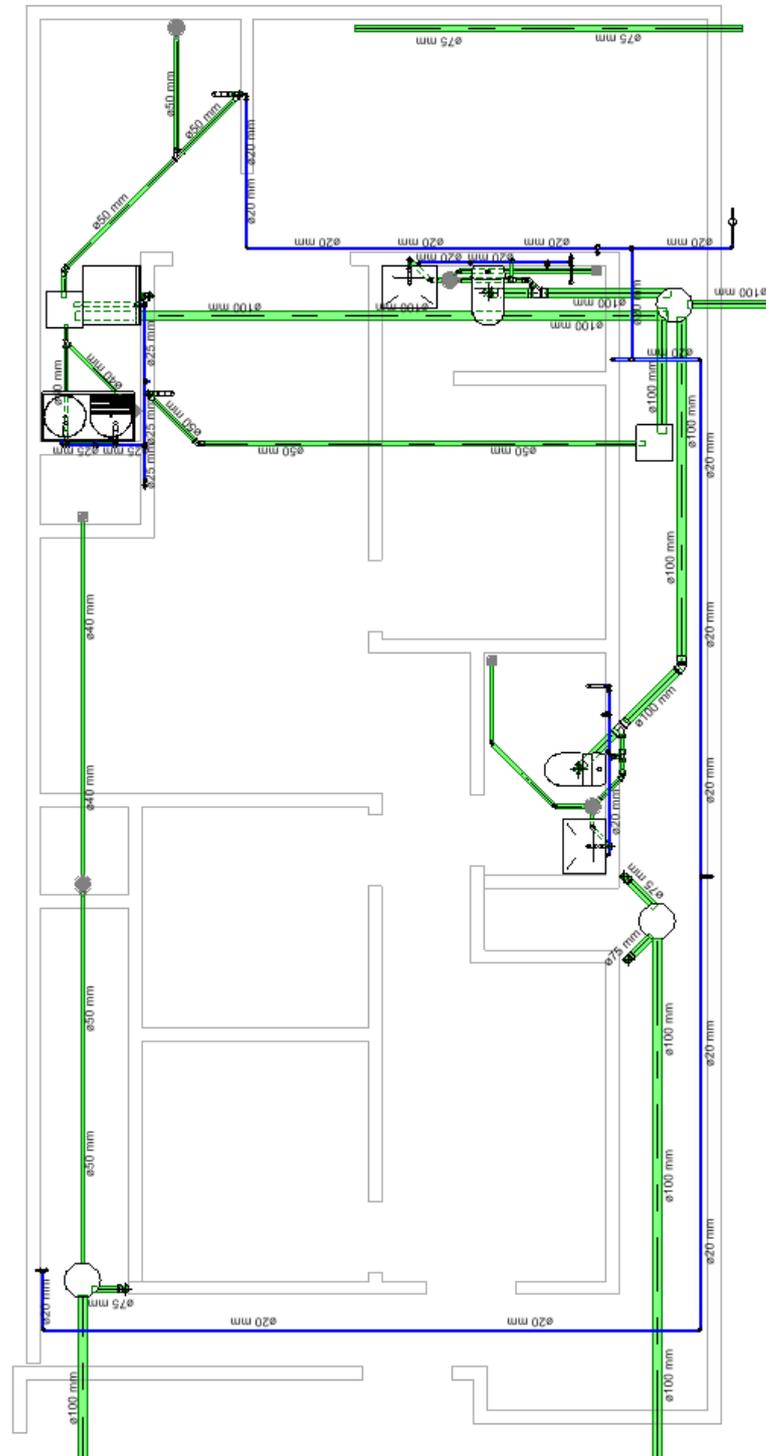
Planta de Coberta Projeto hidrossanitário AutoCad
